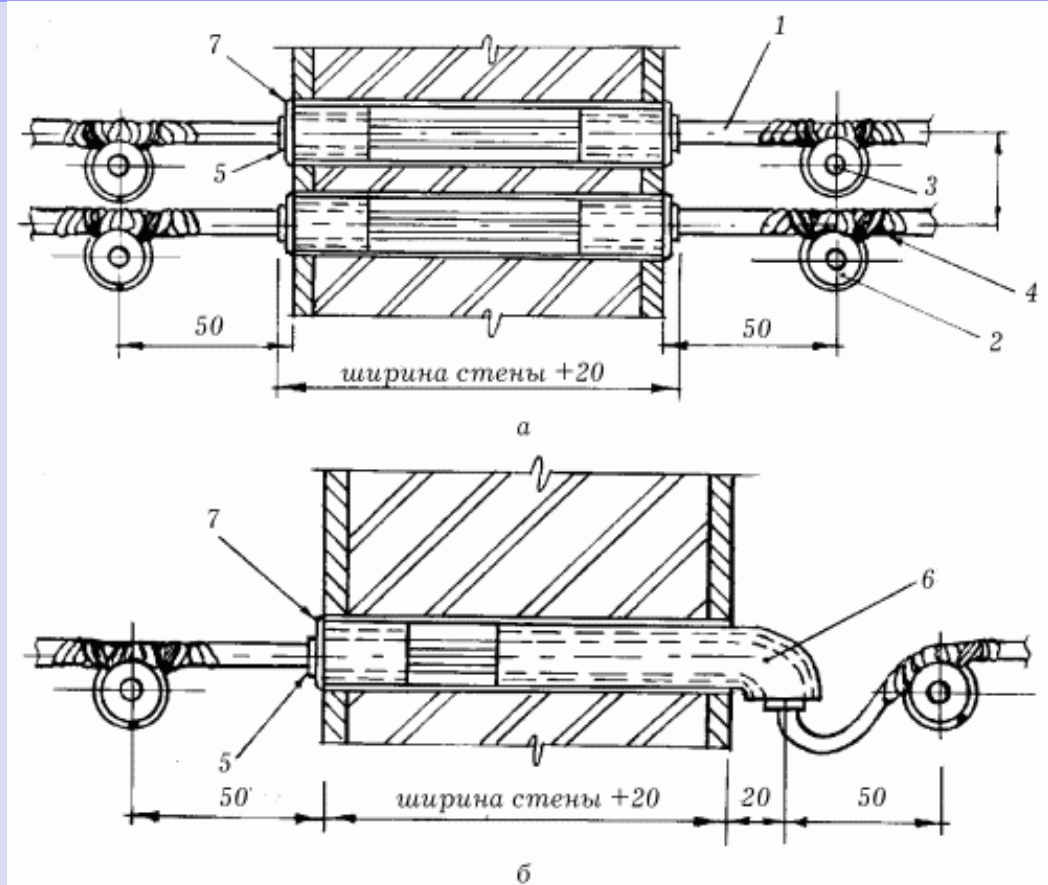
Монтаж электропроводки при прокладке ее через стены и междуэтажные перекрытия в помещениях: а – переход из сухого помещения в сухое; б – переход из сухого помещения в сырое: 1 – провод; 2 – ролик; 3 – шуруп; 4 – прорезиненная или полихлорвиниловая изоляционная лента; 5 – изоляционная трубка; 6 – воронка фарфоровая; 7 – втулка фарфоровая.
